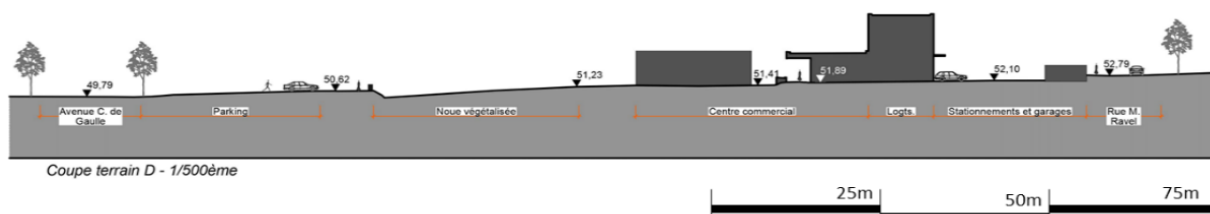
Ilots futurs : coupe de l'existant (source : PHARO)
